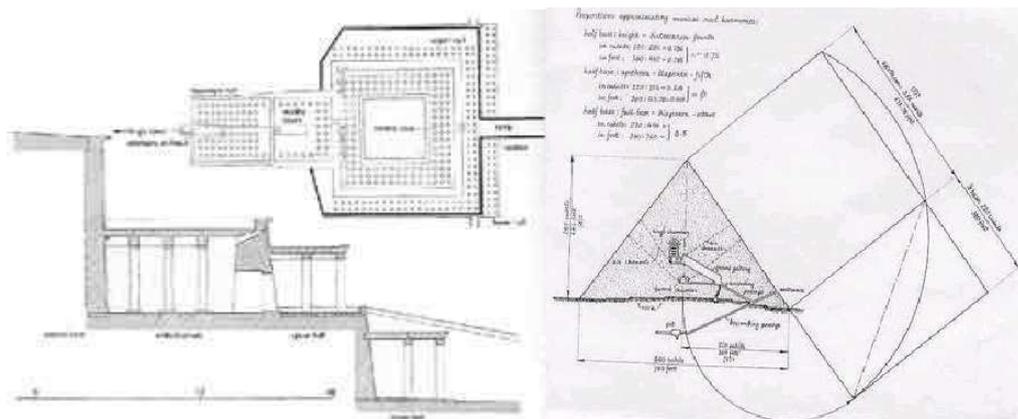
Planta Baixa de um templo egípcio e planta de uma câmara mortuária também egípcia.
